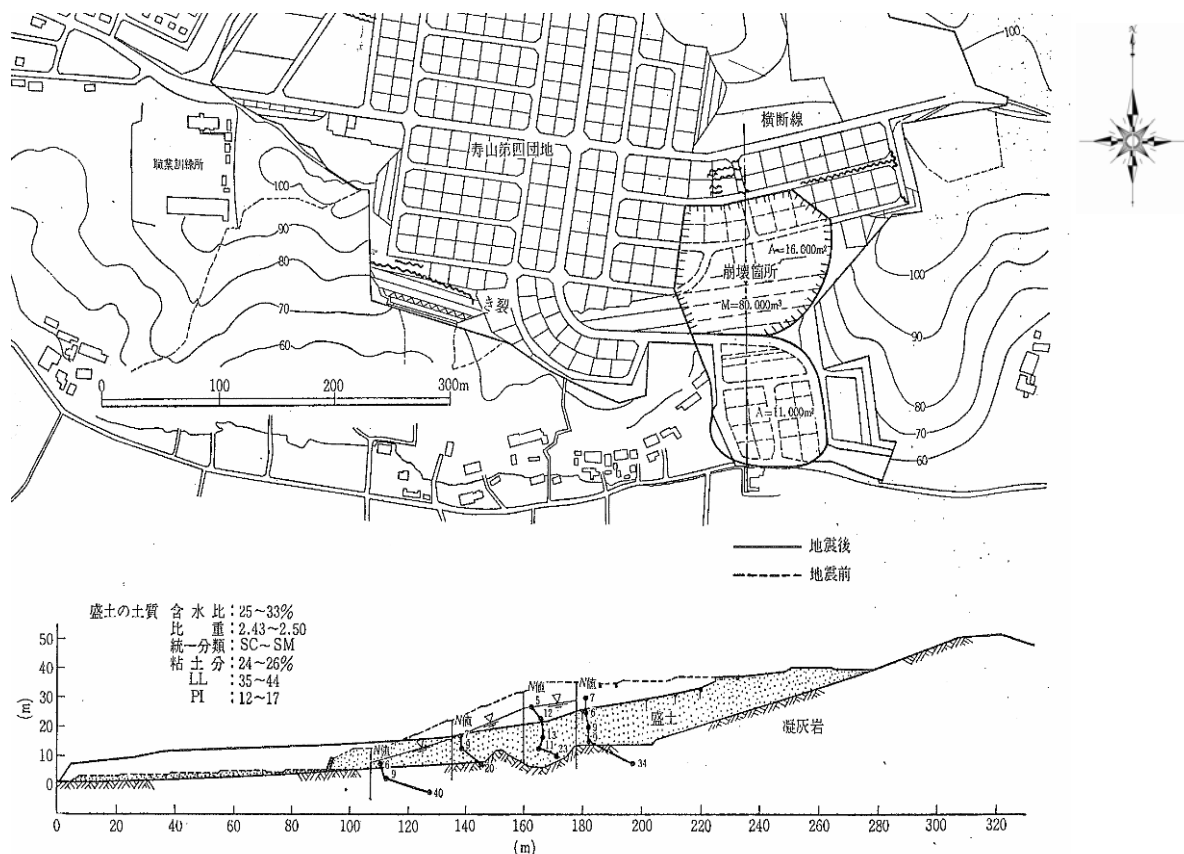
1978 年宮城県沖地震時における白石市 A 団地の被災範囲平面図および断面図³⁾
